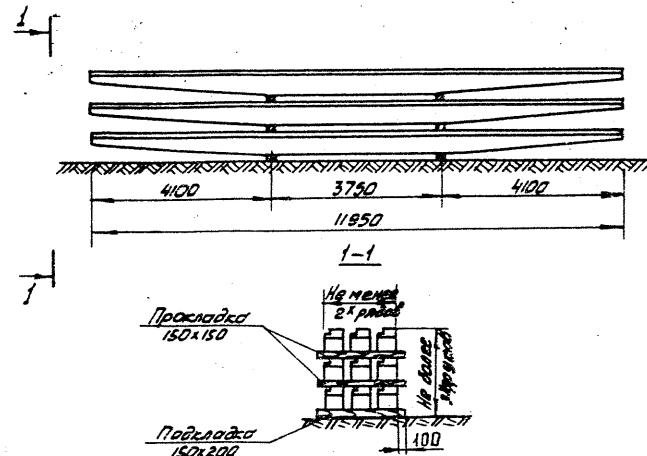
Складирование блоков перекрытия СБНОС-12
